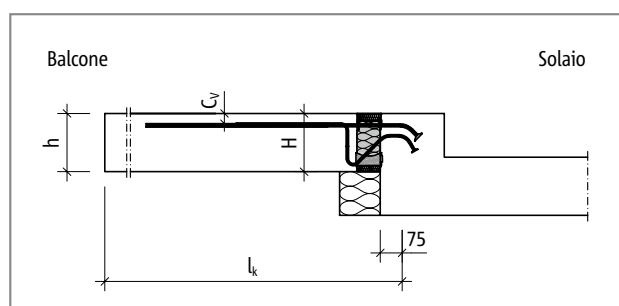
Schöck Isokorb® T tipo KL-O: schema statico
